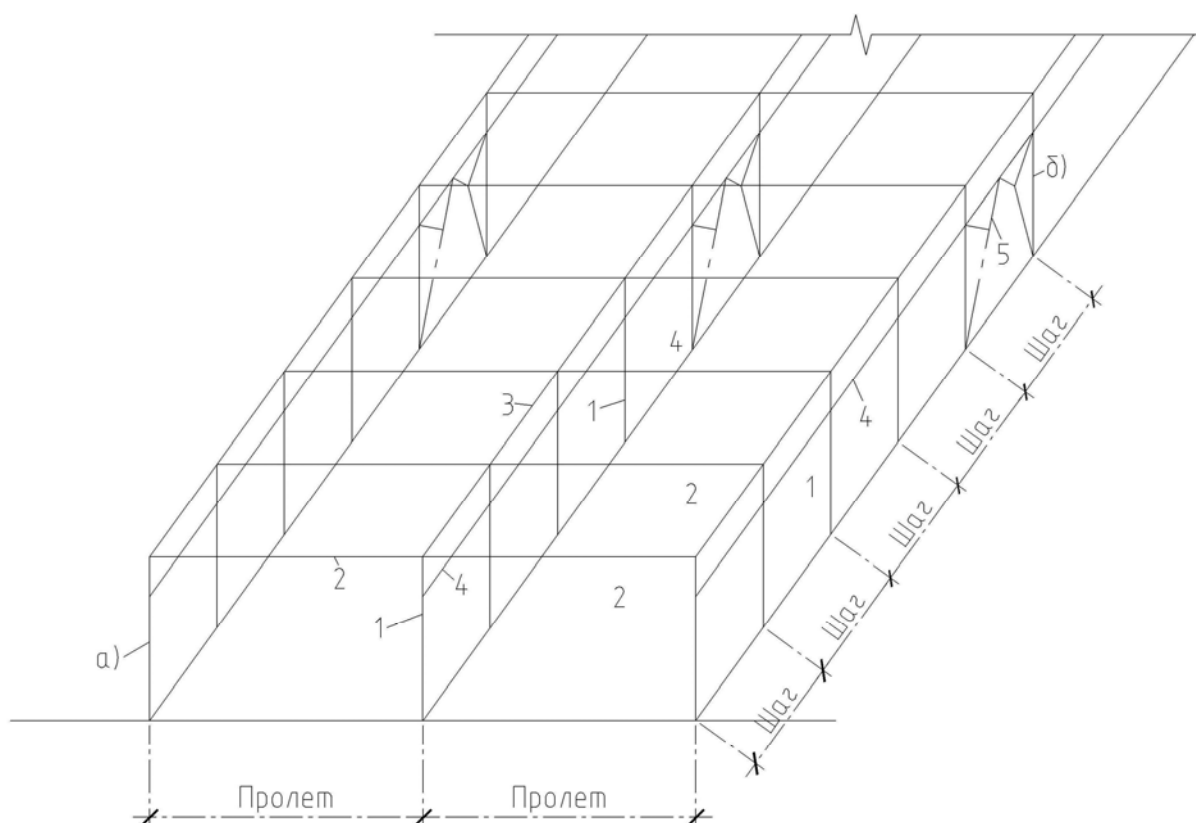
Схема поперечных и продольных рам одноэтажных зданий:
